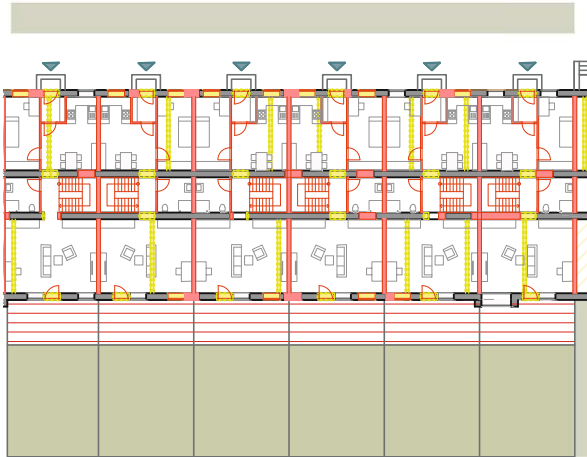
Rot-Gelb Plan Reihenhaustypus M 1:500
